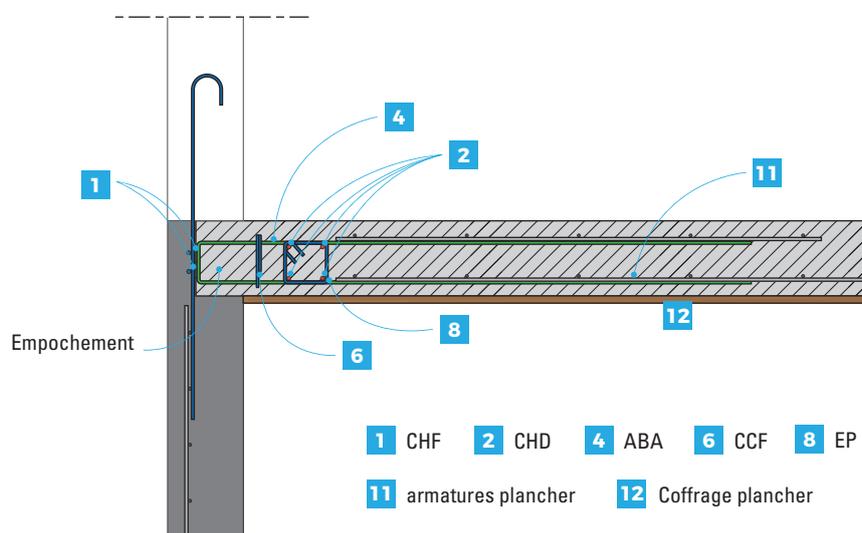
Solution 2 – Réservations au droit des bandes d'appui : Exemples de dispositions de ferrailage – Coupe sur bande d'appui
